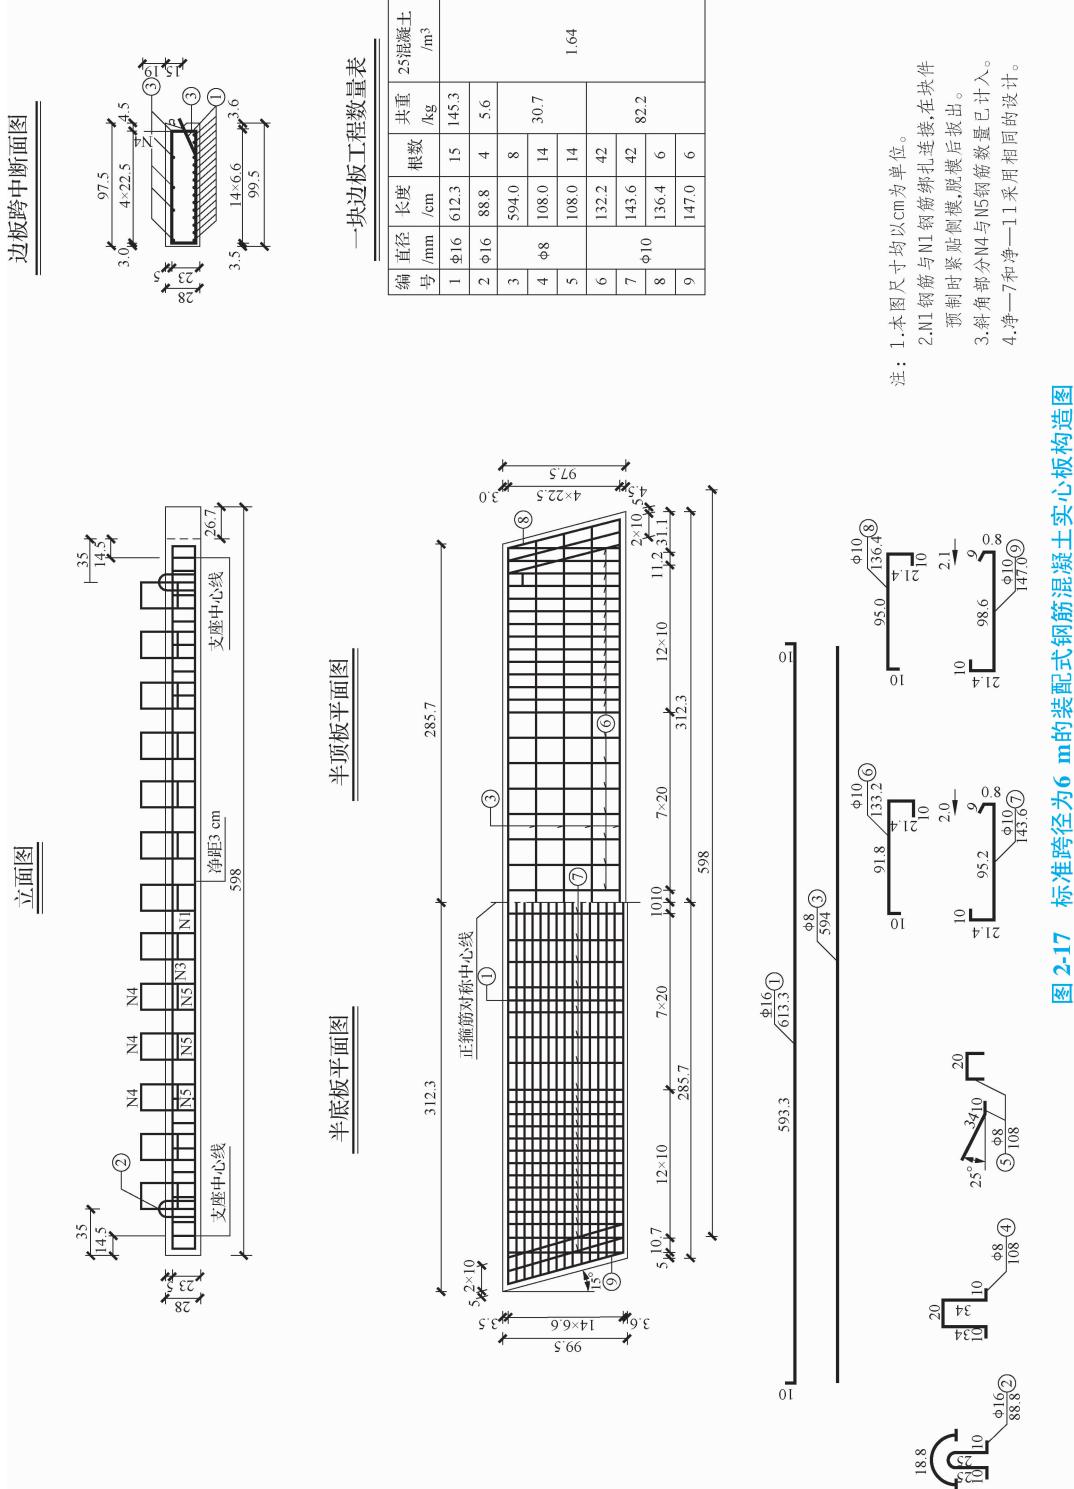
标准跨径为 6 m 的装配式钢筋混凝土实心板构造图
